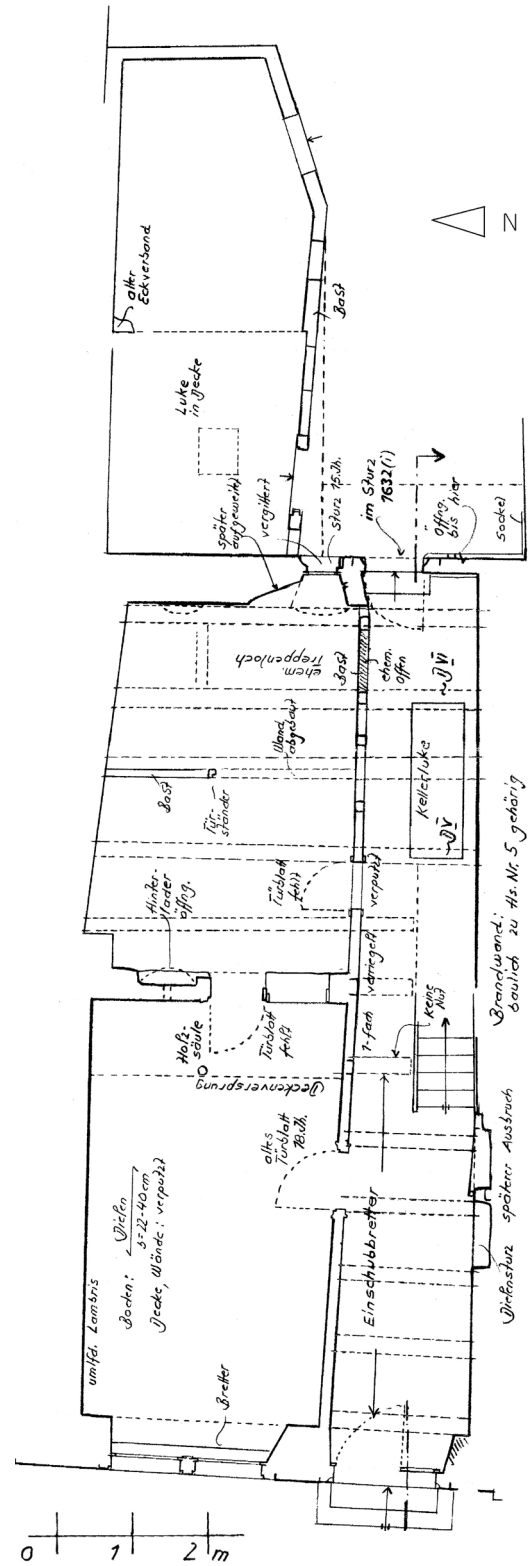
Adlergasse 3, Grundriss Erdgeschoss.
